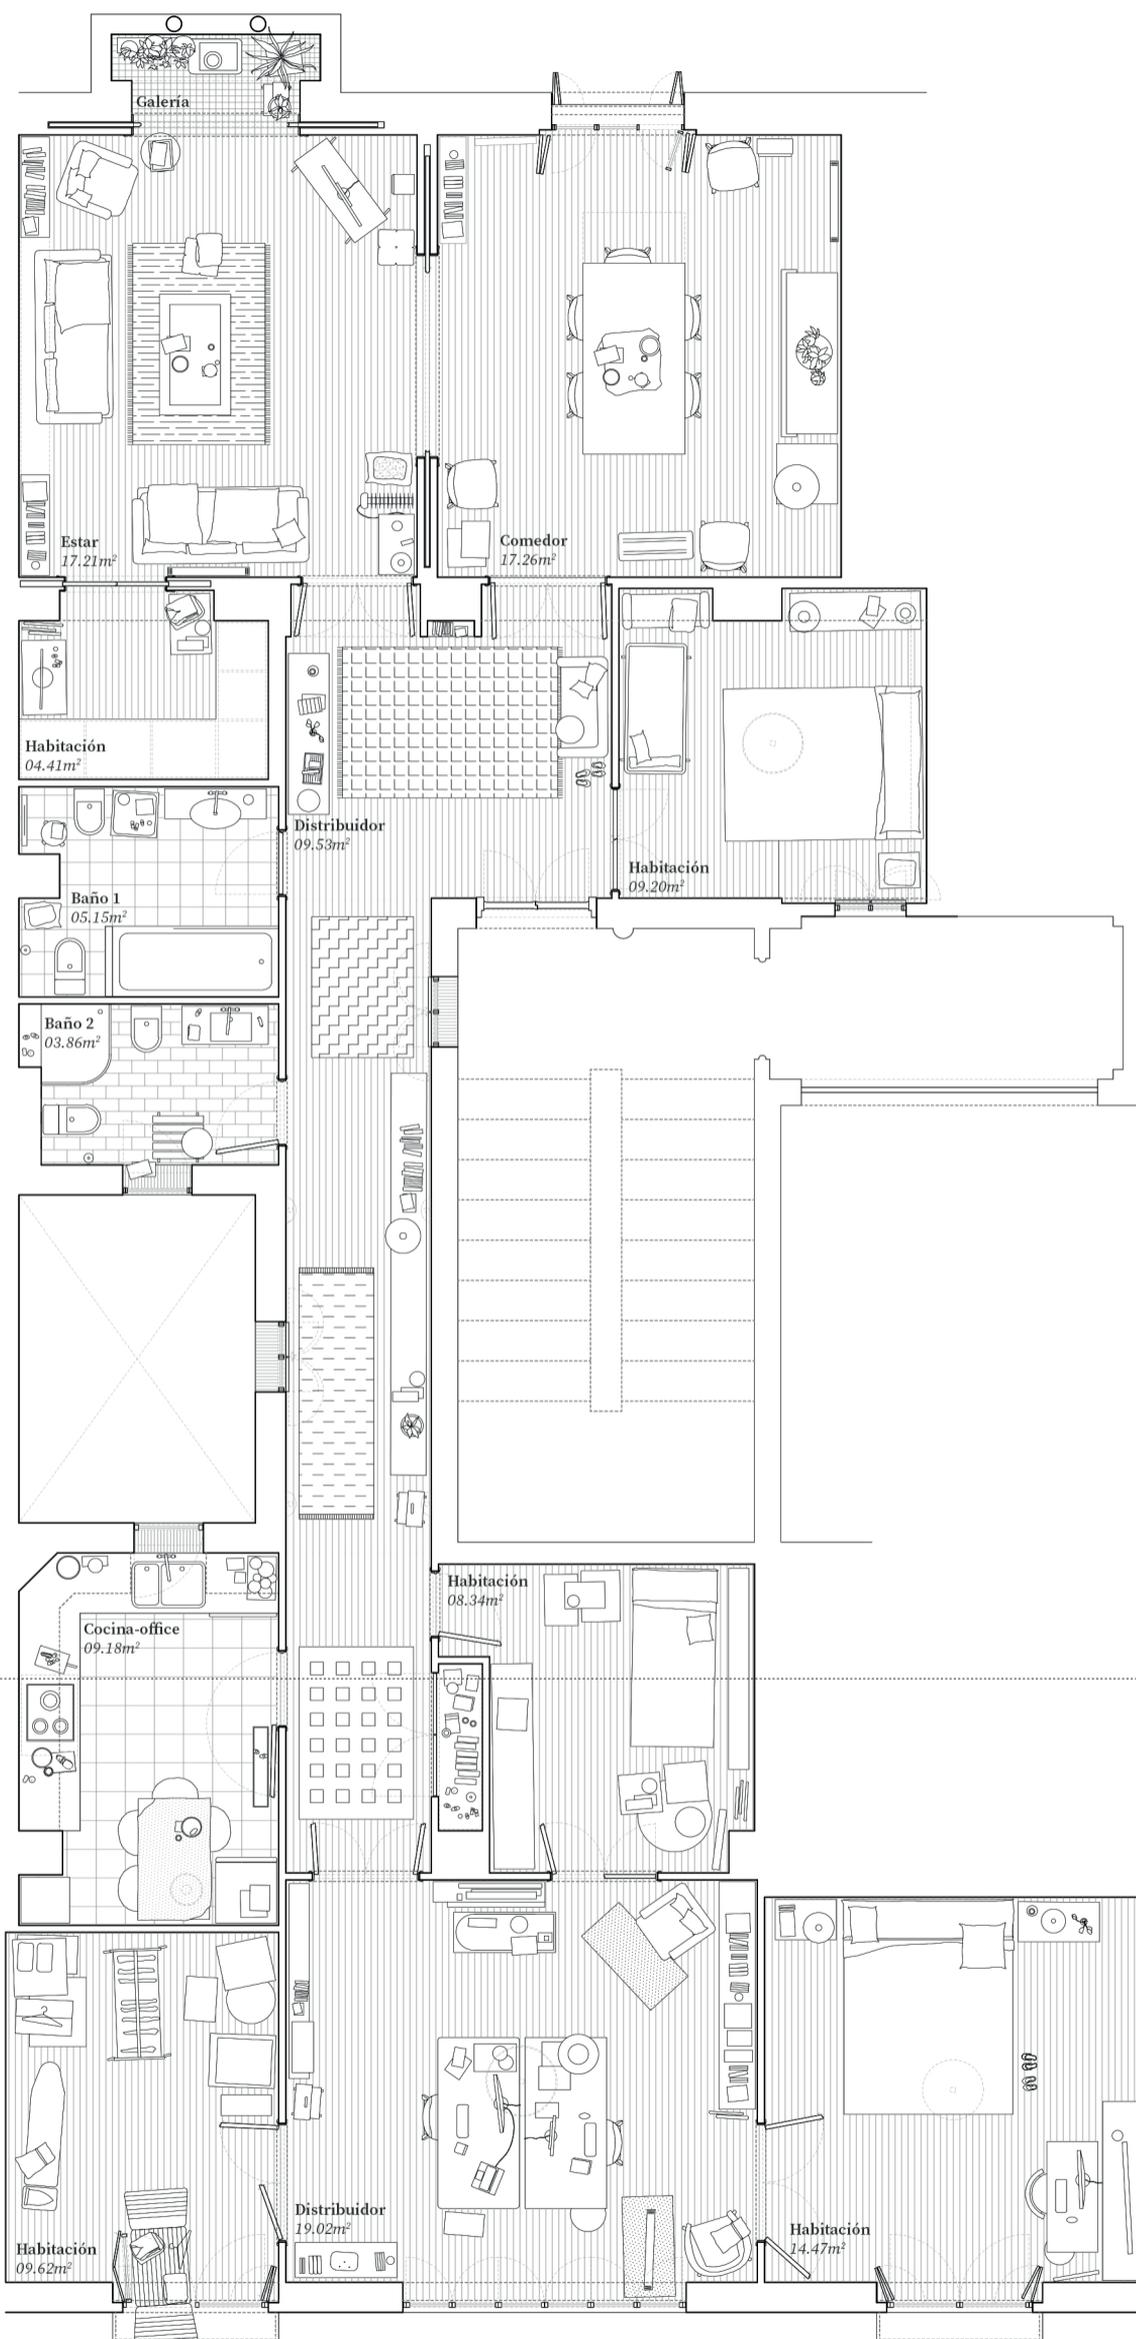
Planta de la vivienda del proyecto de Cortina. Escala 1:75. Fuente: elaboración propia.
